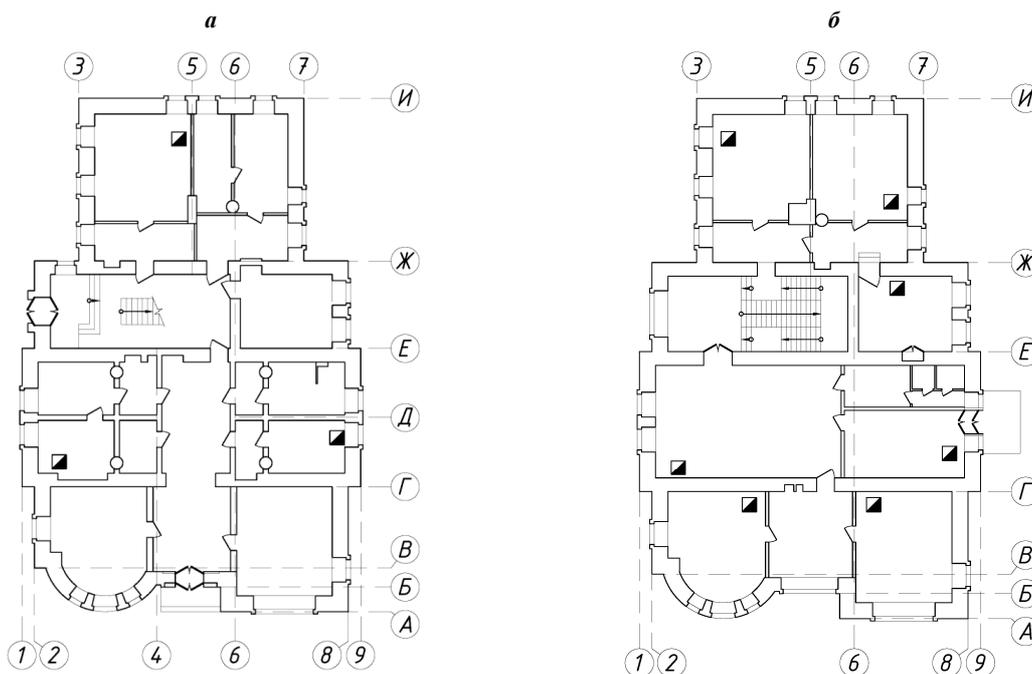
Планы усадебного дома: 1-го этажа (а); 2-го этажа (б)
